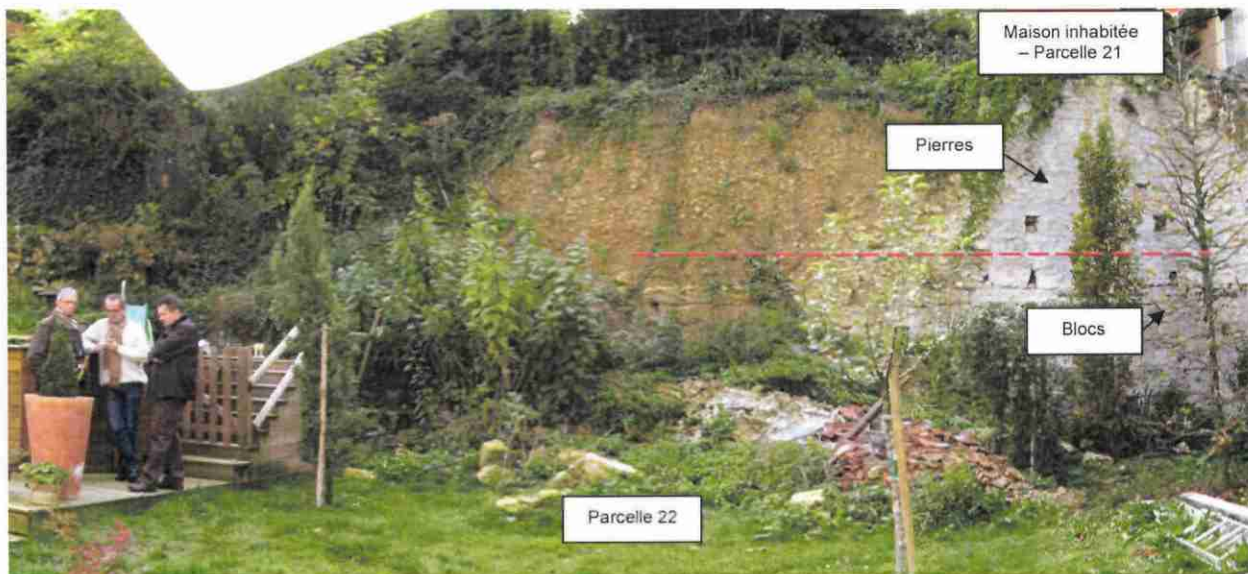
vue du mur de soutènement effondré (photo BRGM).
